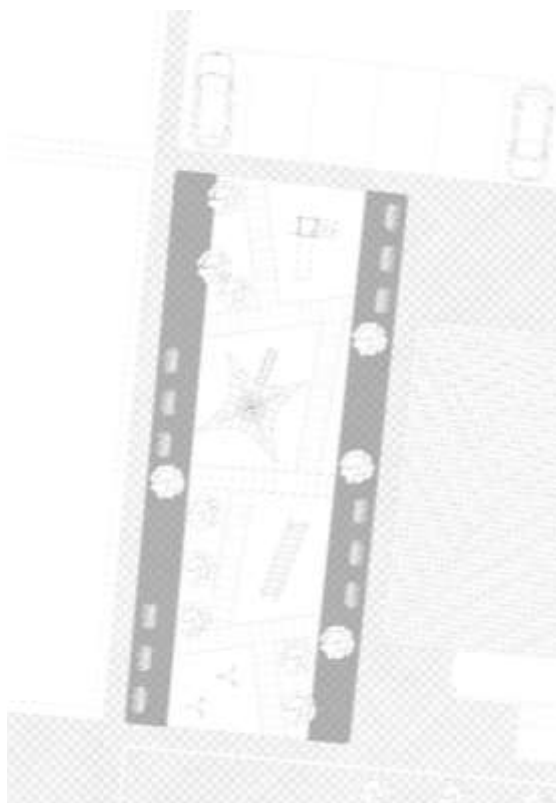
Planta de pormenor da proposta de reabilitação, zona para crianças.
